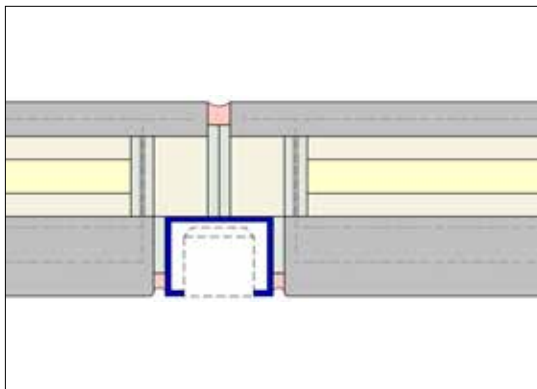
Fassaden-Sandwichelemente (FSE), Einbindung Elektro (kbp)
